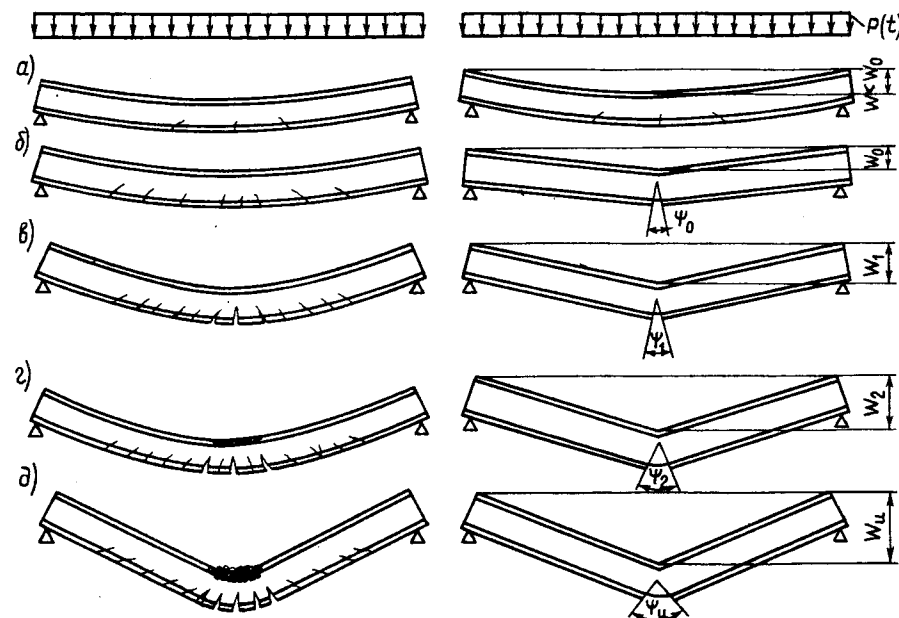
Действительные и расчетные схемы деформирования изгибаемого железобетонного элемента
